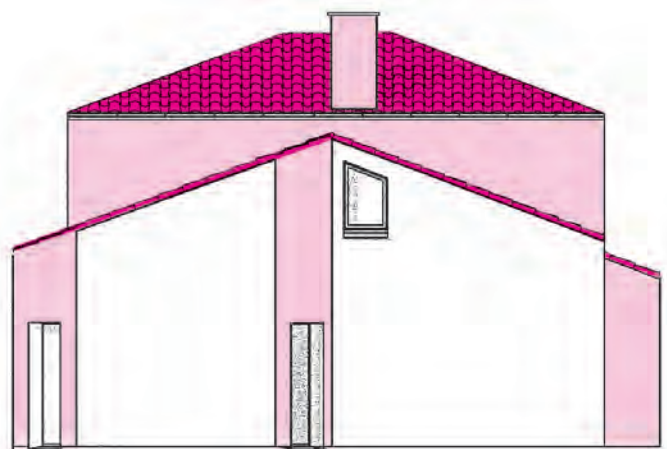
Façade de droite avec les murs pignons du rez-de-chaussée et de l'étage
